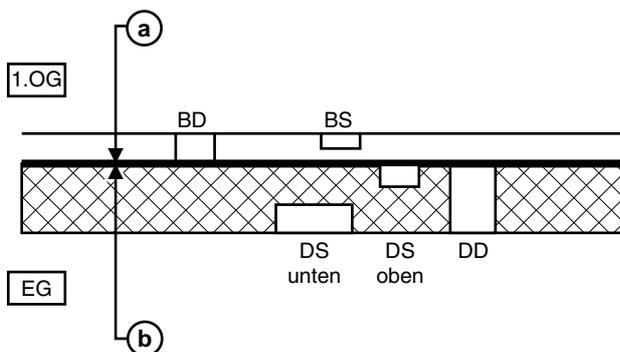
Eintragung von Aussparungen in Decken (b) und Bodenkonstruktionen (a)
